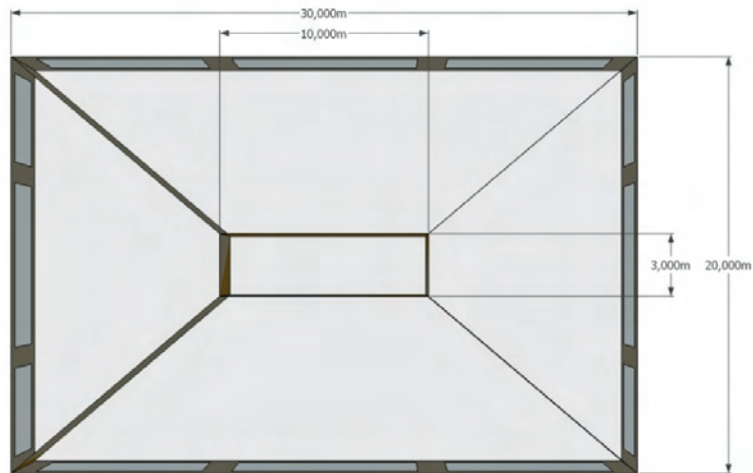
Grundriss Regelgeschoss mit fünf thermischen Zonen [S. Gosztonyi, M. Brychta, AIT]
